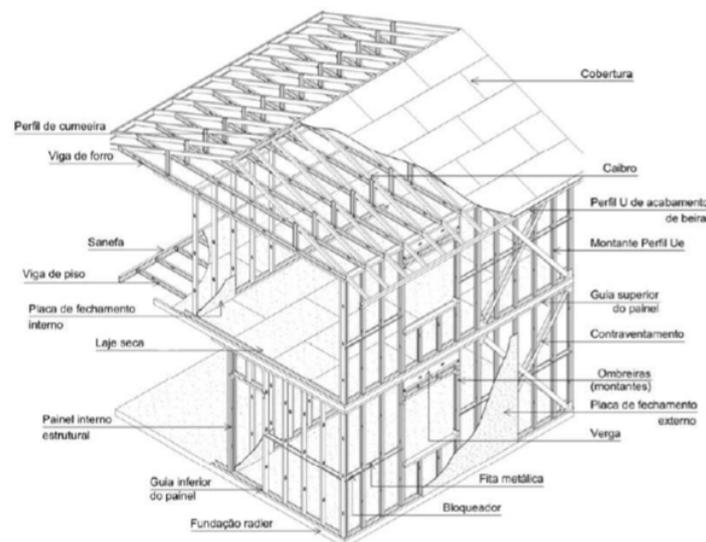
Esquema construtivo LSF. Fonte: CASTRO (2005)
